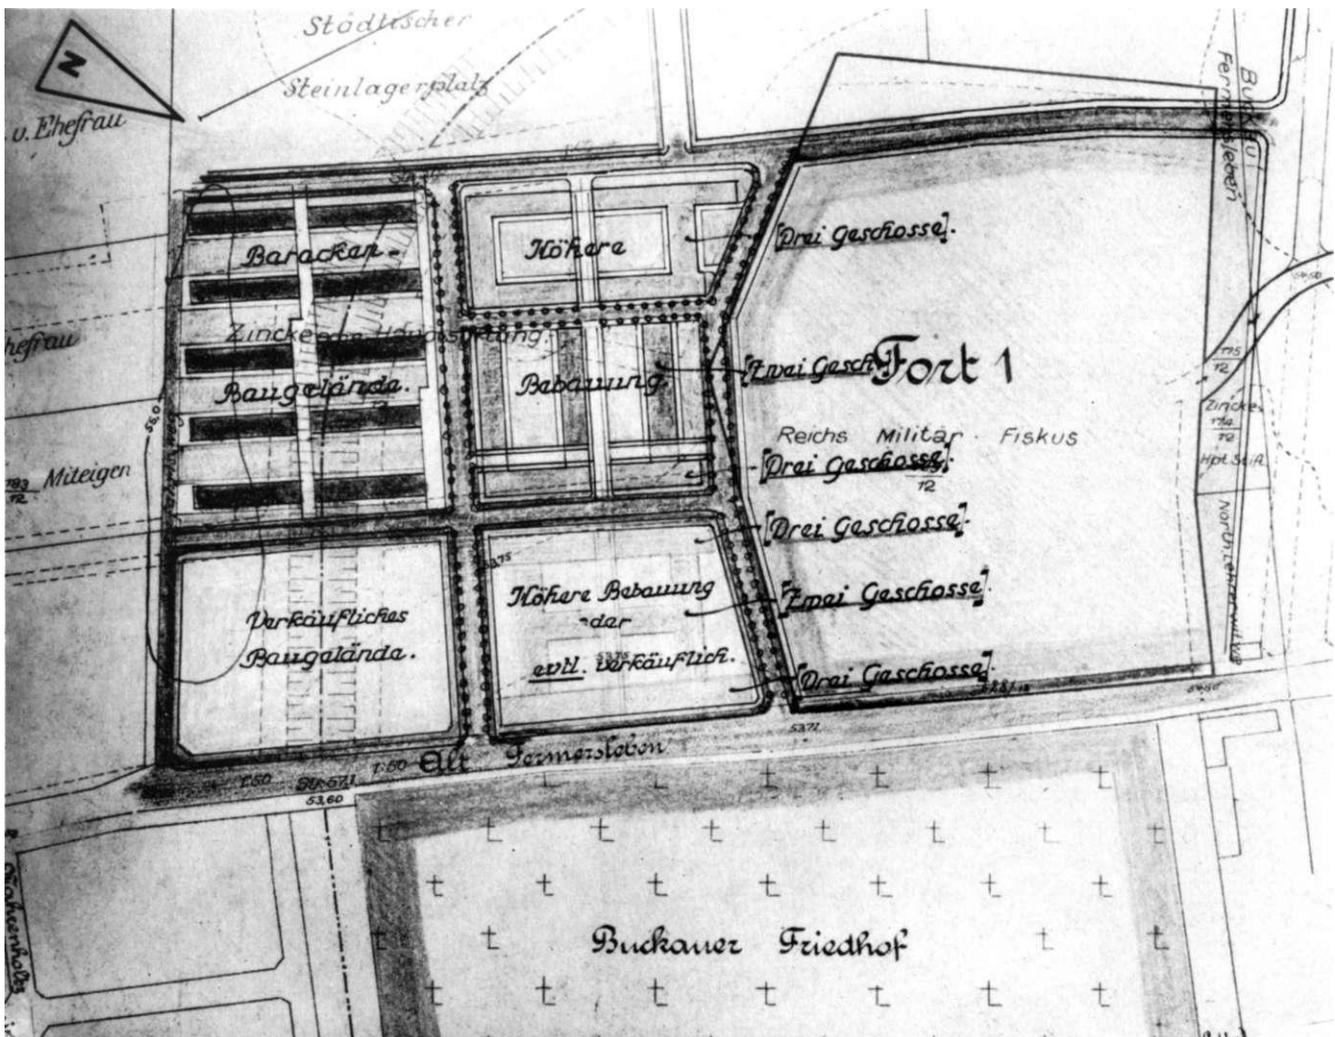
Bebauungsplan für das Gelände am Fort 1 mit Industriebahntrasse etwa 1919/20
